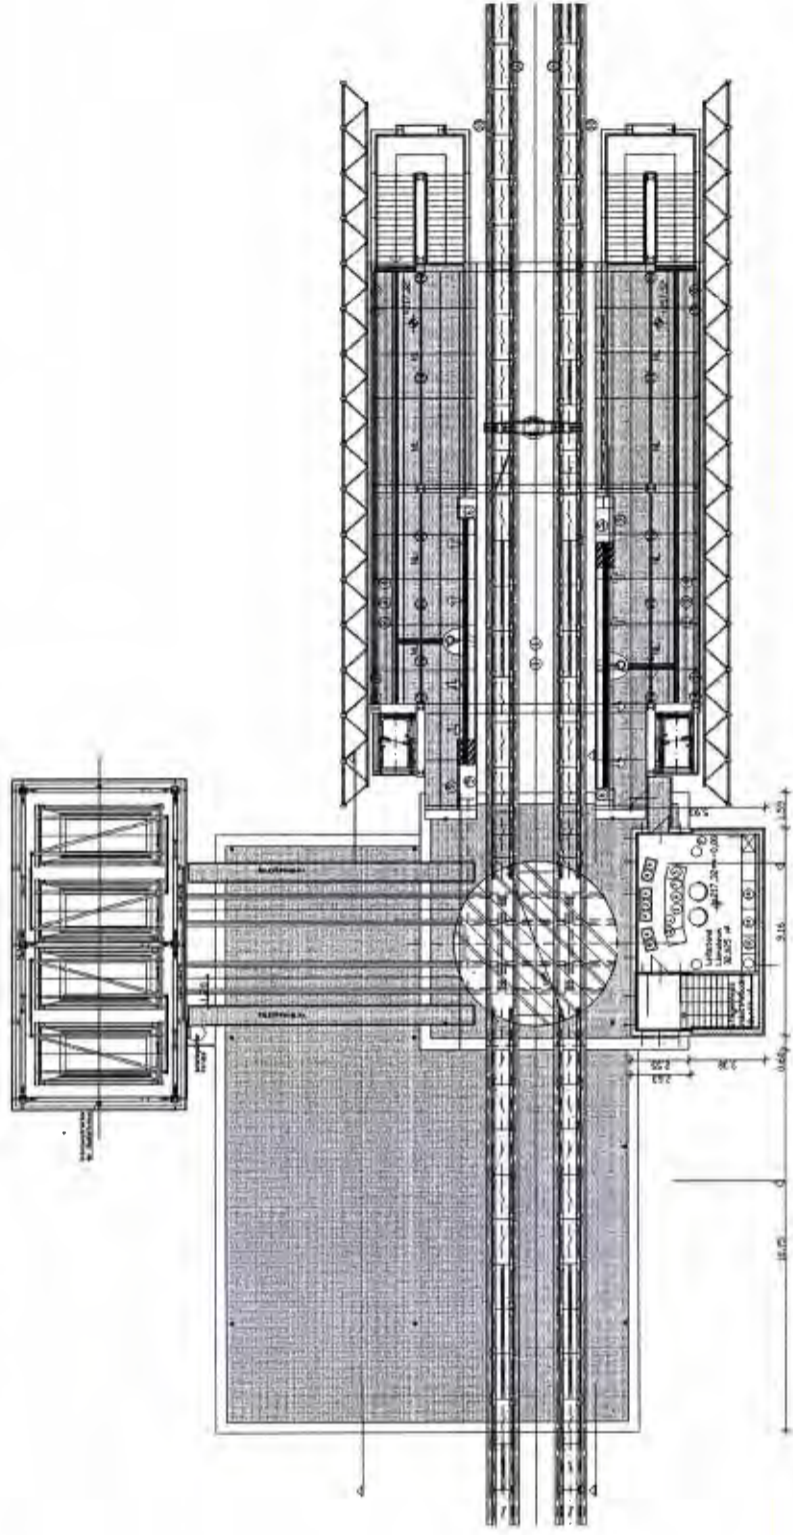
Plan sentralstasjon, eksempel.
